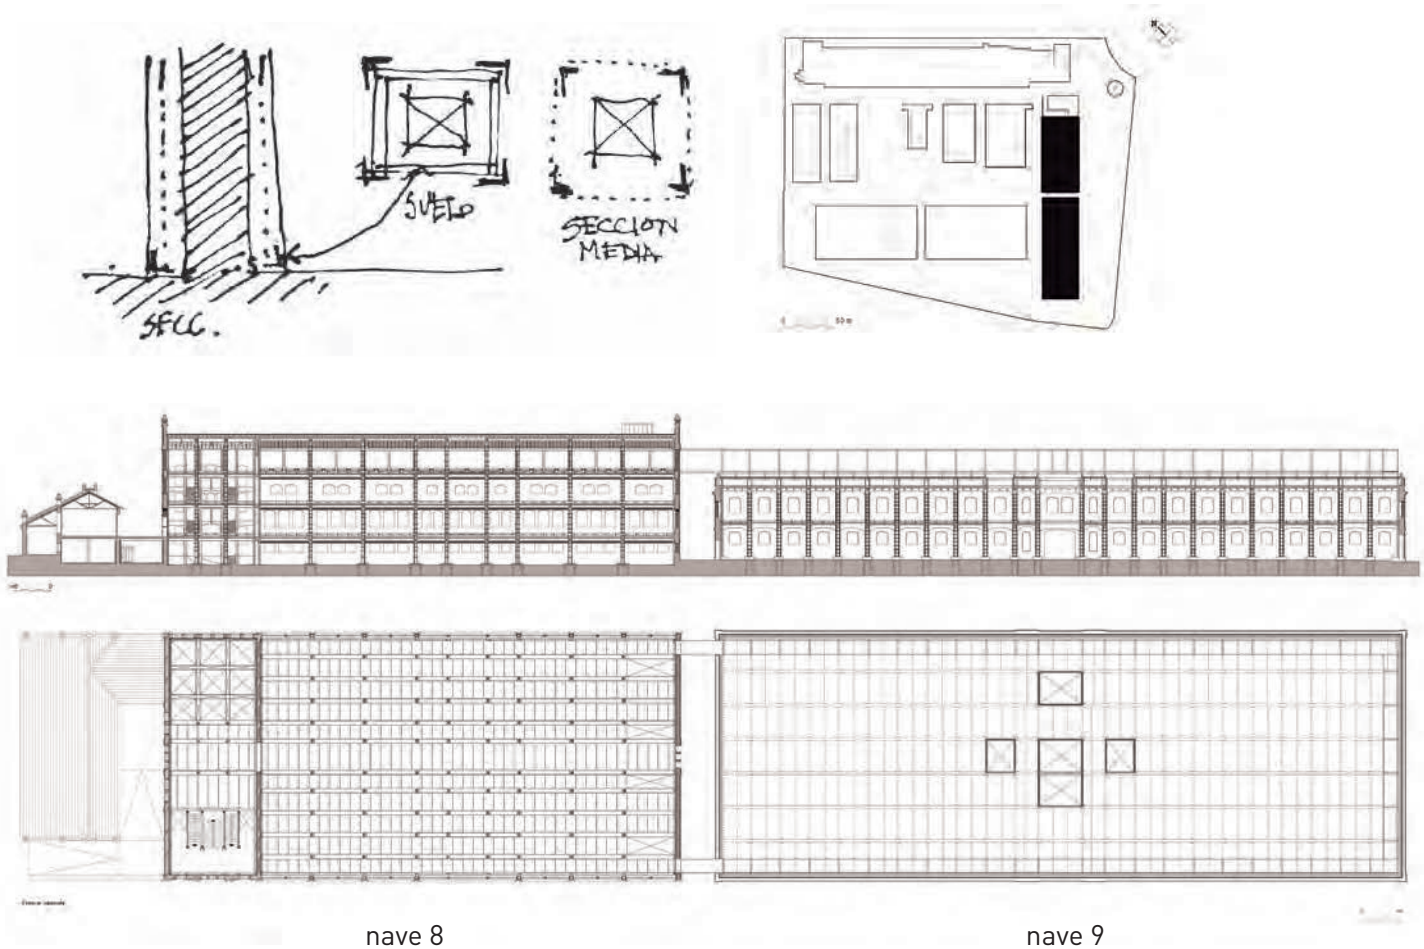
\_Naves 8 y 9, esquema conceptual del refuerzo estructural y planos cedidos por el autor Arturo Franco.
